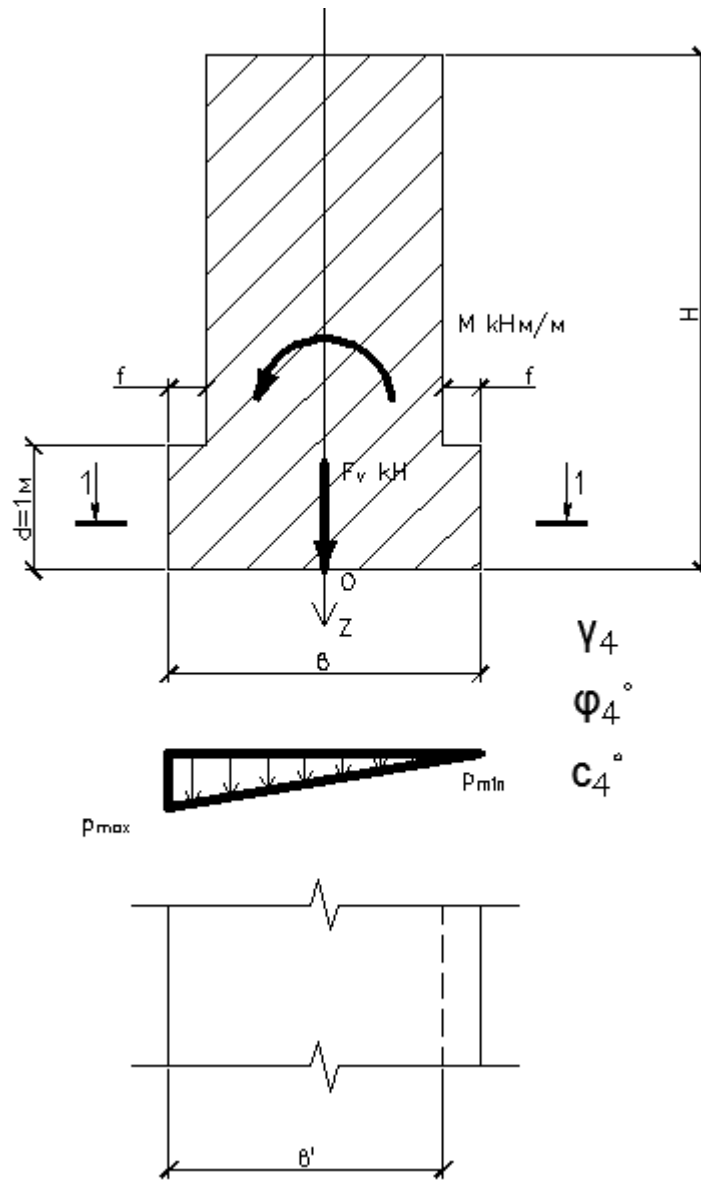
К определению ширины фундаментной части подпорной стенки b
